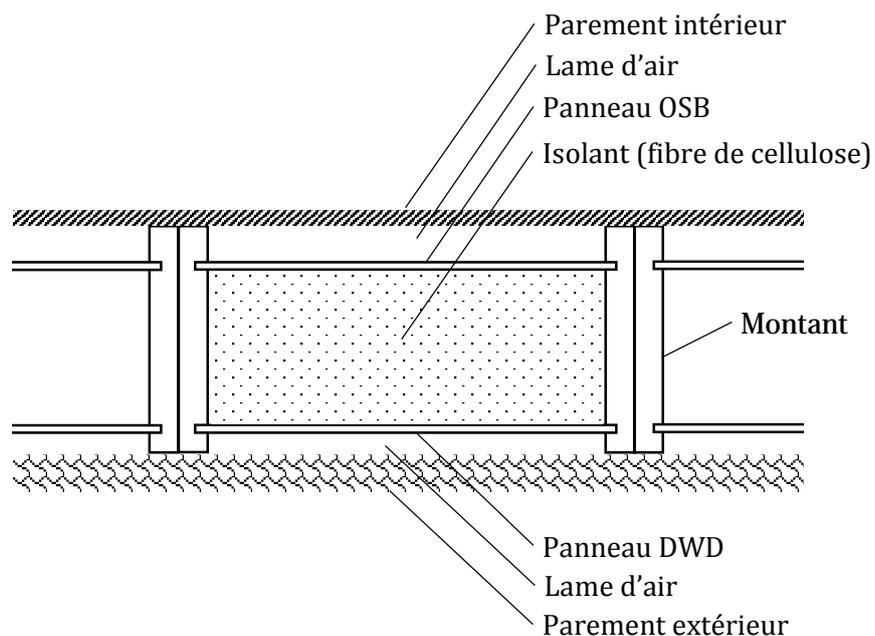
SYSTÈME QUICK BOX ORIGINAL : SCHÉMA D'UN CAISSON (VUE EN PLAN)
